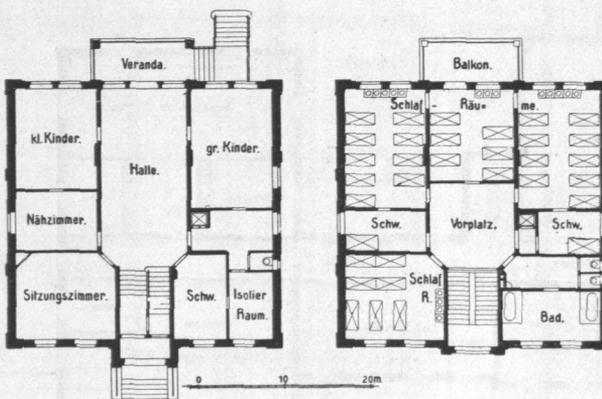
und 614. Borsteler Kinderheim, Erd- und Obergeschoss, Grundriß.
